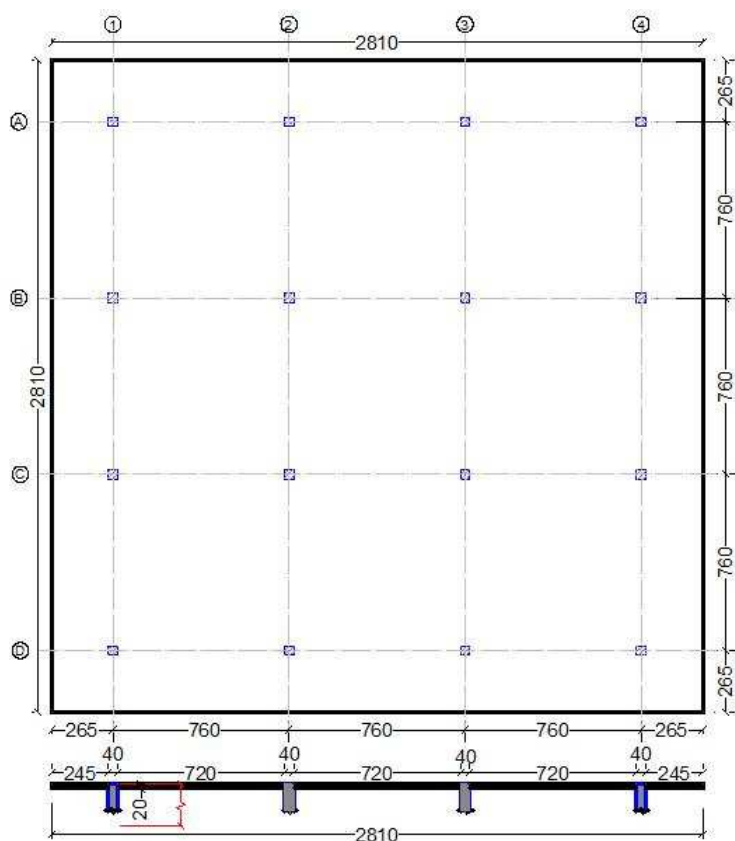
Planta baixa e elevação da FÔRMA_10
